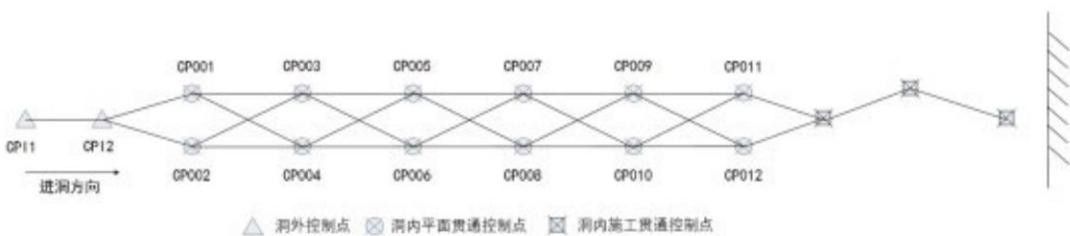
洞内平面贯通控制网与洞内平面施工控制网关系示意图
